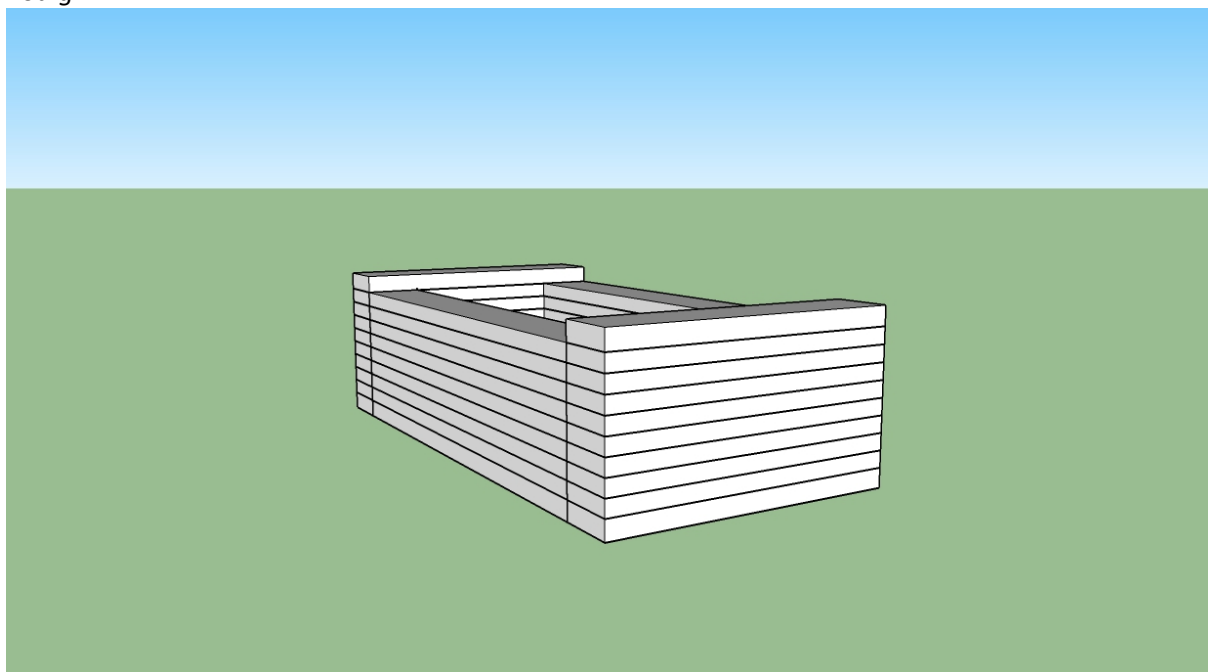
Plan Looping Towers gezien vanaf Bisonspoor (kijkend richting noorden/spoor/kanaal)
